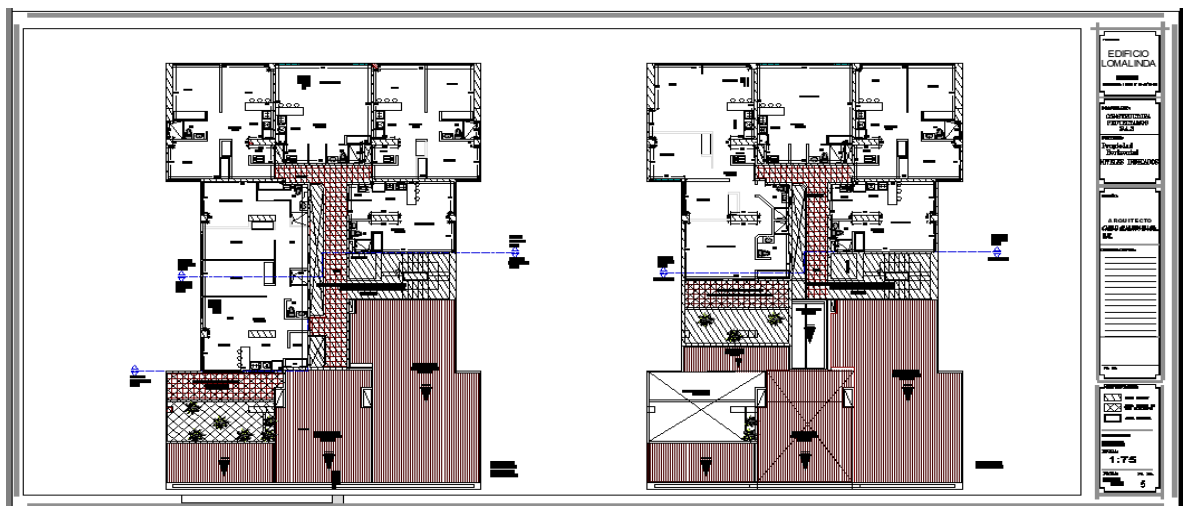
PLANO PROPIEDAD HORIZONTAL – PLANO 4.
